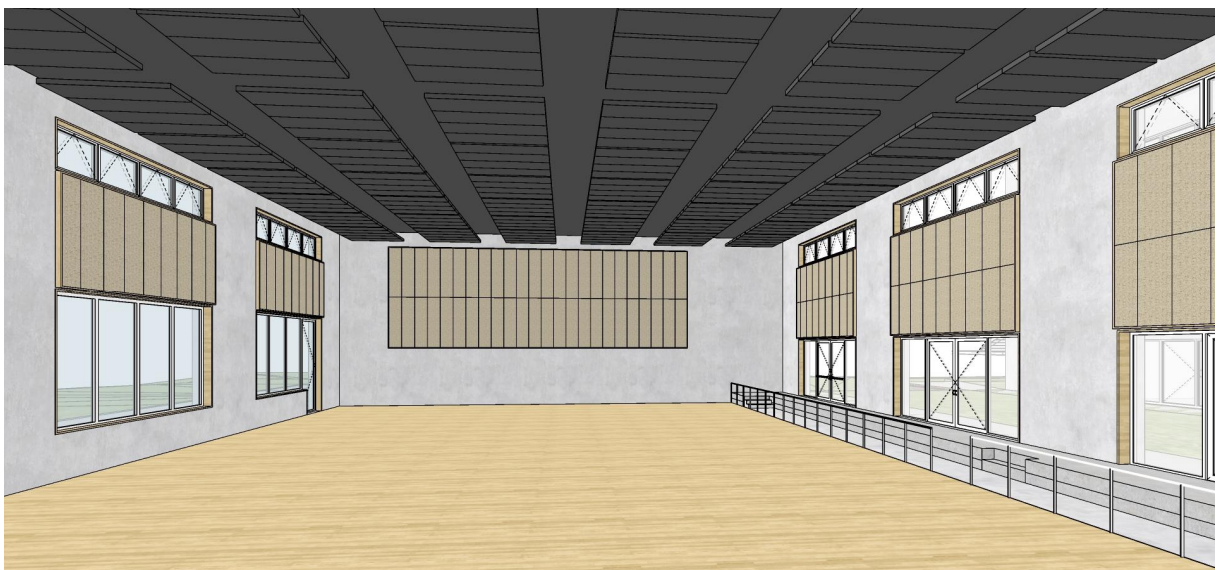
Prospetto Est con indicazione dei pannelli a parete (pannelli in fibra di legno mineralizzata con retrostante pannello in lana di roccia spess. 75mm)
